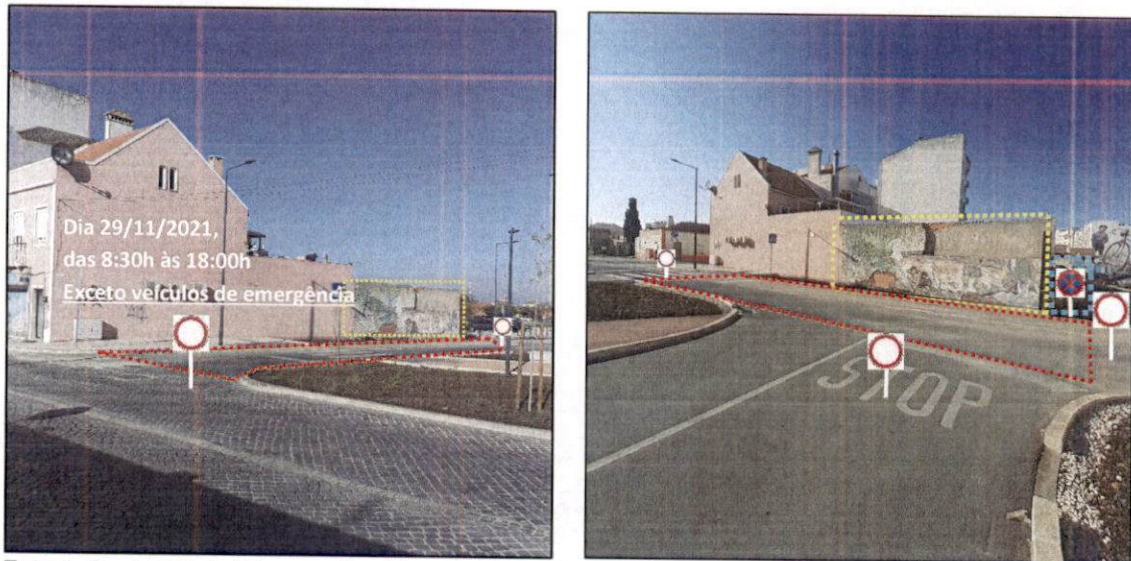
, 2 – Local de intervenção - Rua da Estação do Barreiro-A, Barreiro, UFBL
